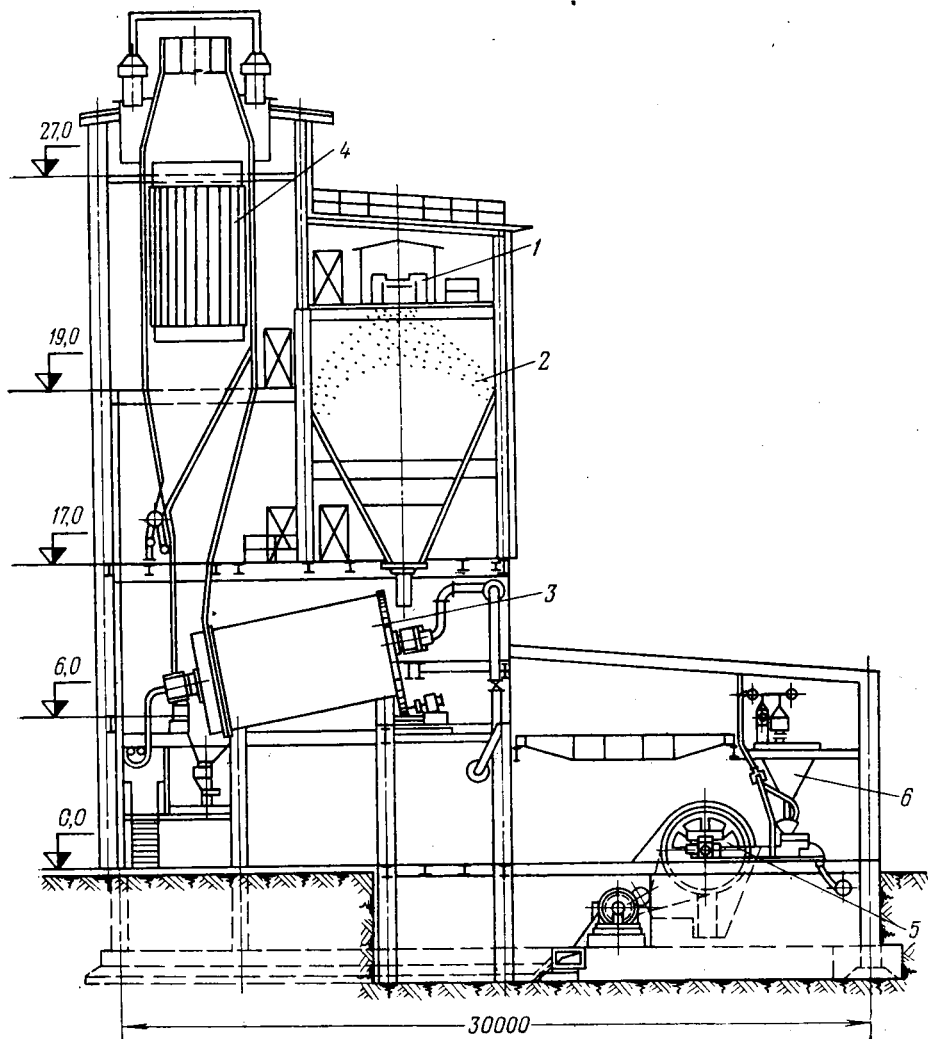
Расположение паровой трубчатой сушилки в сушильно-прессовом корпусе брикетной фабрики:
